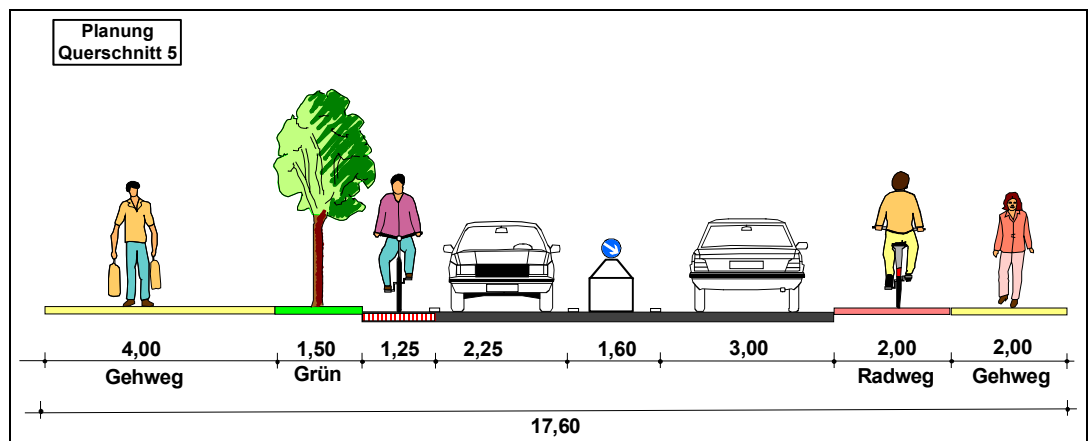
Elsässer Straße – Planung Abschnitt 5
